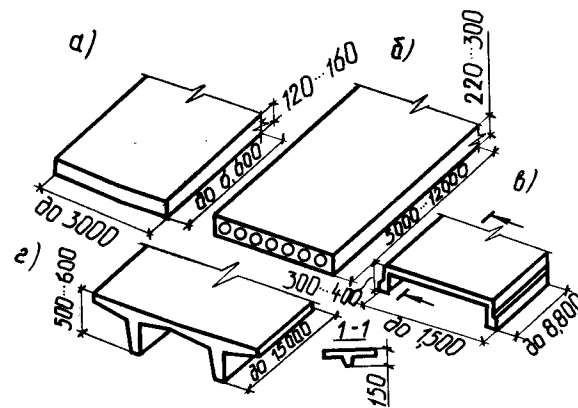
Плиты перекрытий многоэтажных зданий:
